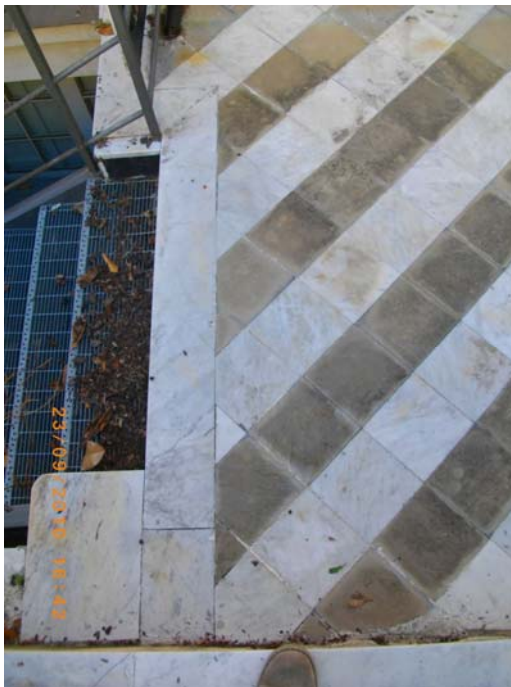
7 : 'VELA' (Intervento A) – Pavimentazione Esterna – Varco Loggiato Sud
